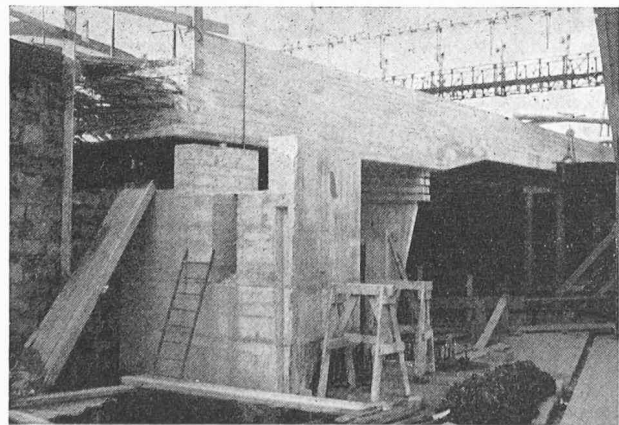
La culée « est », avec le pont-rail reposant sur des cales provisoires au droit des piles intermédiaires.
